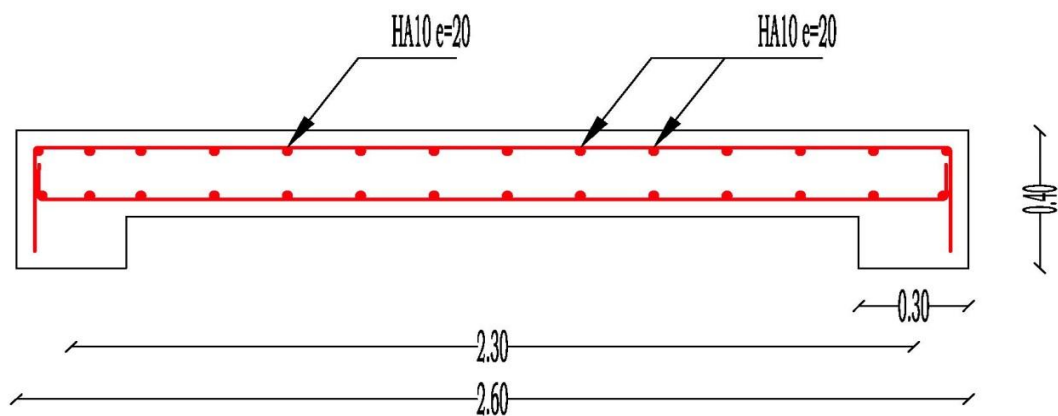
Ferrailage de la dalle machine sens L_y
